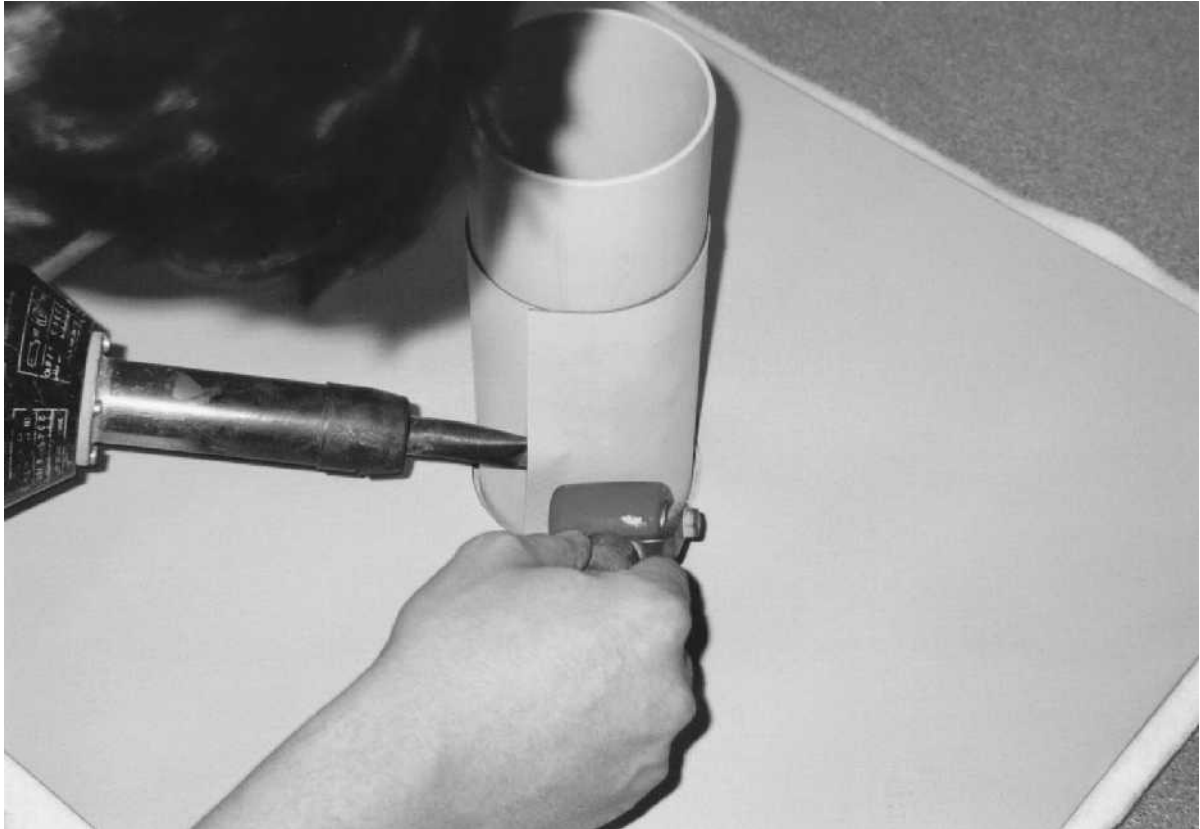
Opracování hydroizolace v koutu a na rohu
